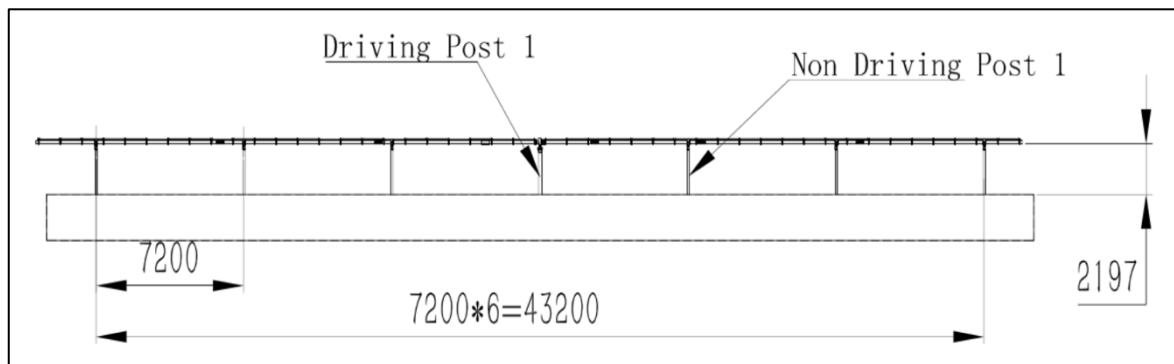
Características del tipo de estructuras para colocación de módulos fotovoltaicos
